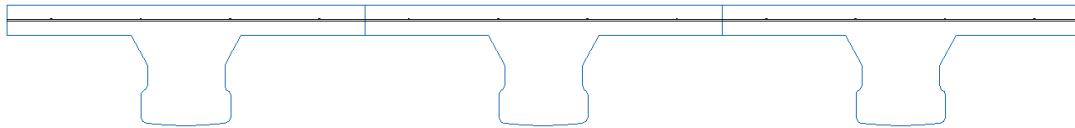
Sección transversal de nervaduras con acero de refuerzo en capa de compresión.
